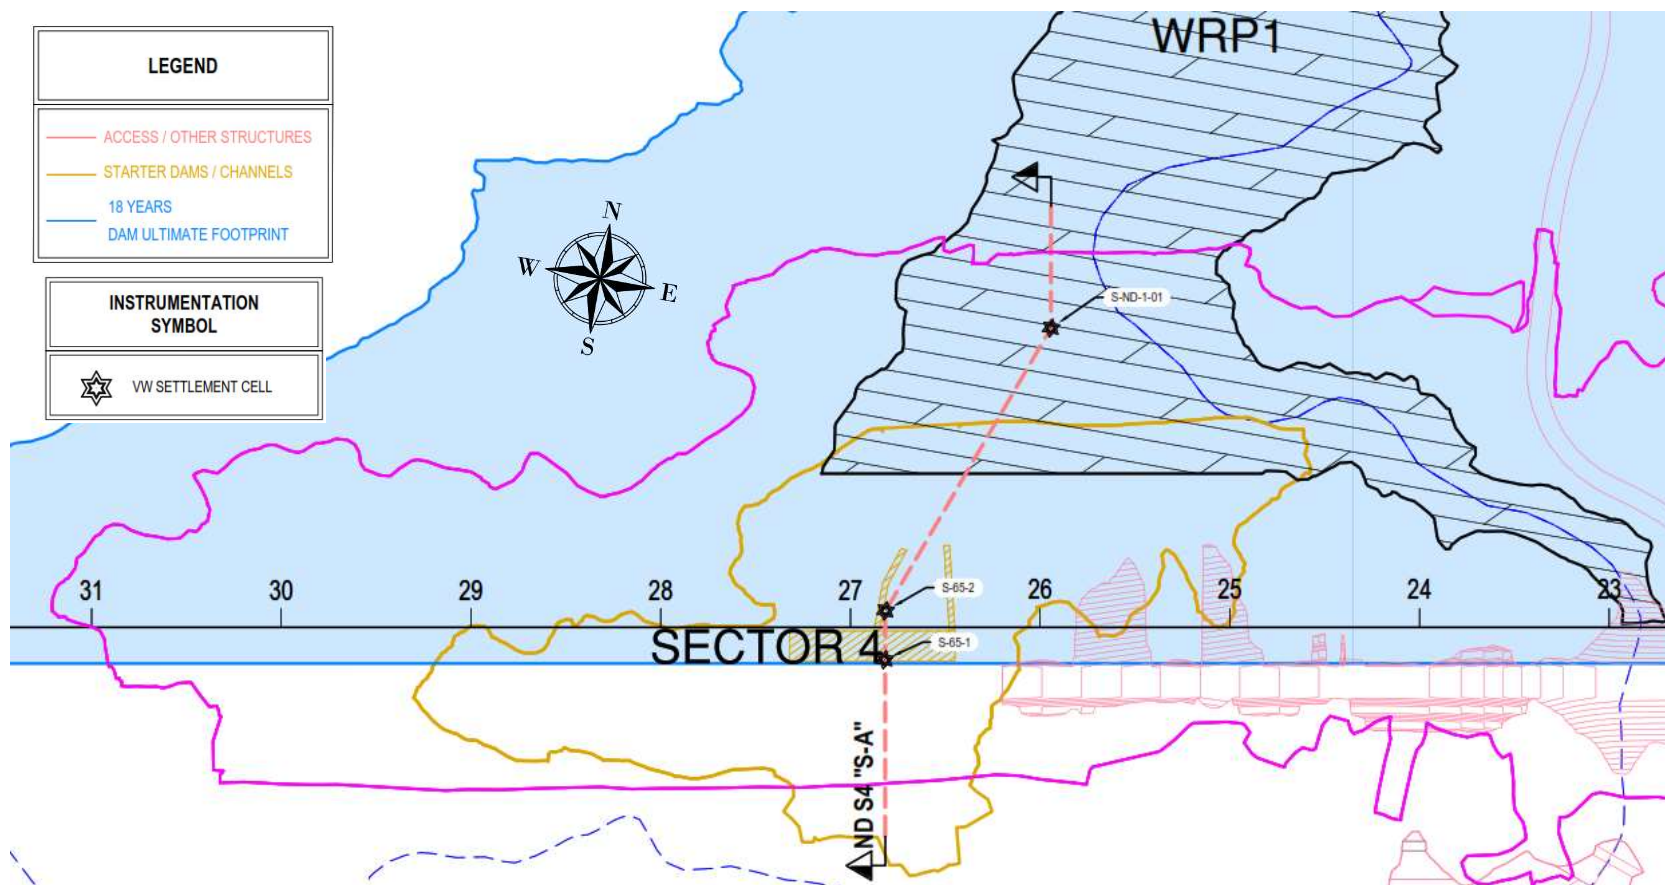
1: Vista en planta del sector 4 de PN - Grupos de instrumentos de celdas de asentamiento
